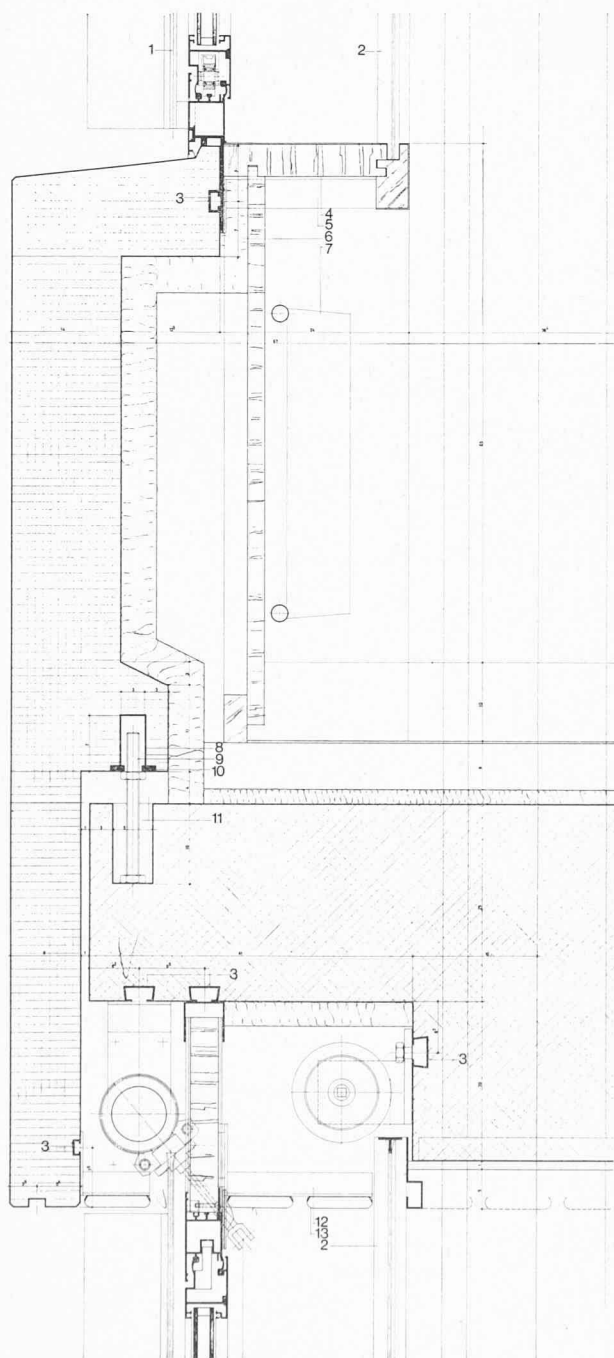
et 14. — Coupes horizontale et verticale de la façade principale (détails).
